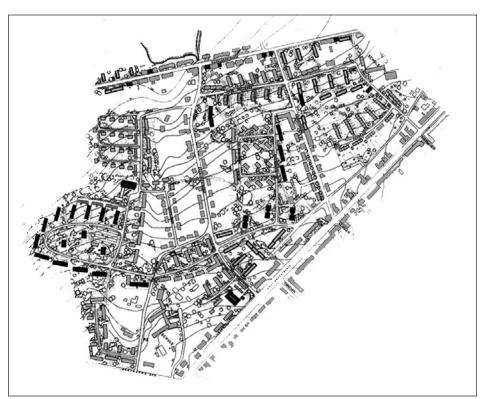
Städtebaulicher Grundriss einer größeren Stahlarbeitersiedlung der 50er Jahre in Bochum
